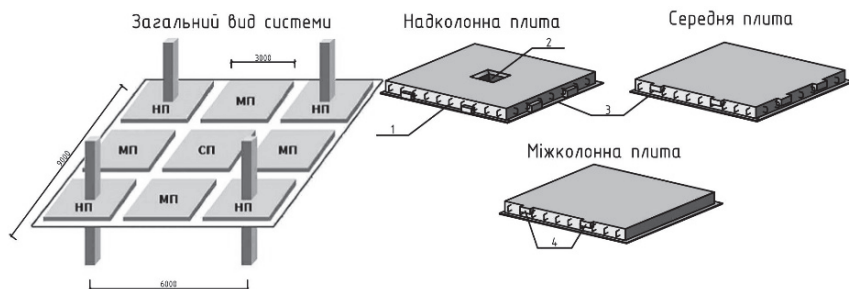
Складові елементи перекриття безбалкового безкапітельного каркасу:
